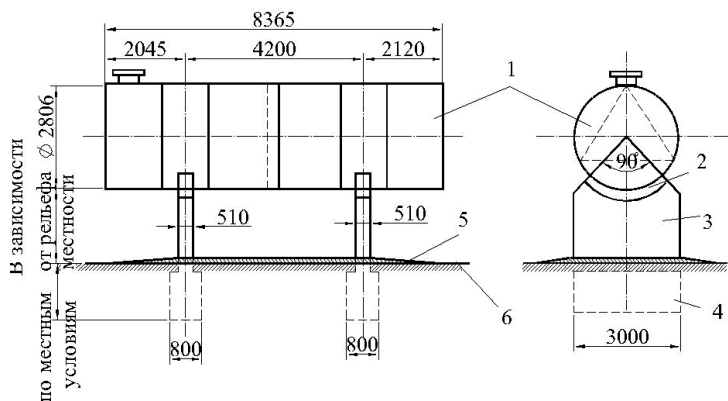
Горизонтальный резервуар с плоскими днищами на седловых опорах: 1 – резервуар; 2 – гидроизоляционная прокладка; 3 – седловая опора; 4 – фундамент; 5 – глиняная отсыпка; 6 – утрамбованный грунт
